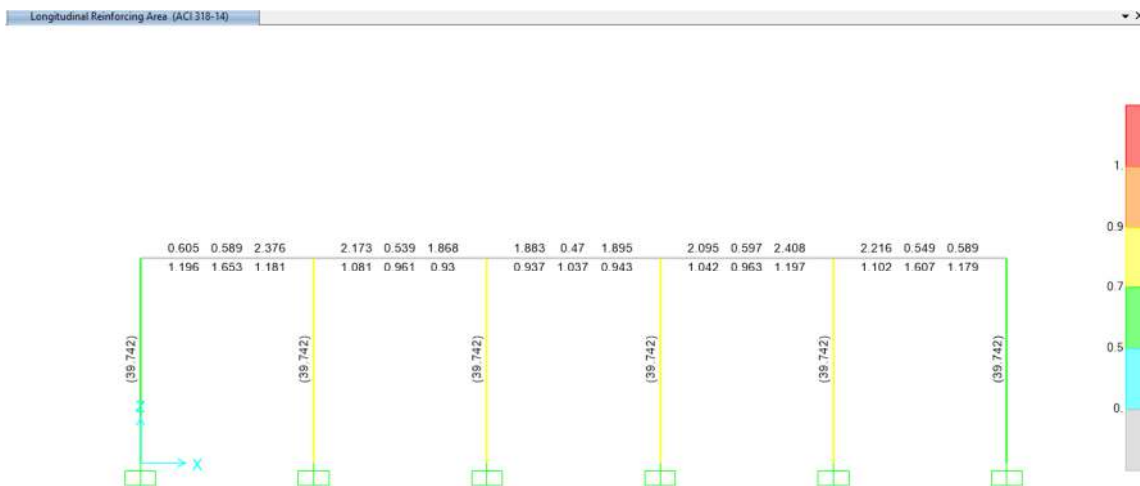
Acero de refuerzo longitudinal en vigas (Requerido)
